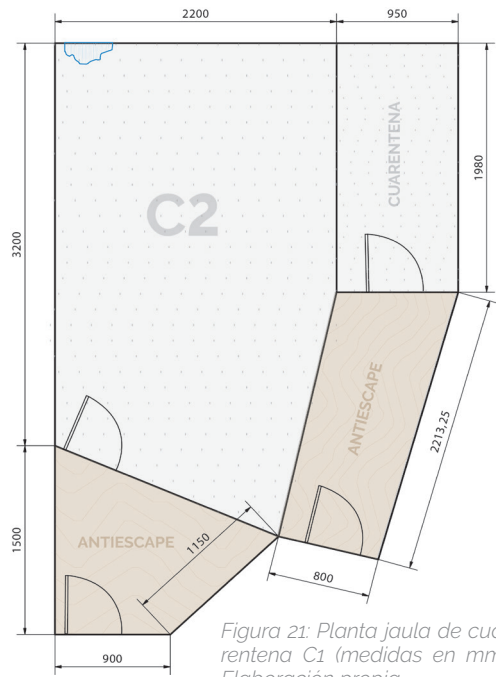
Planta jaula de cuarentena C1 (medidas en mm). Elaboración propia.
